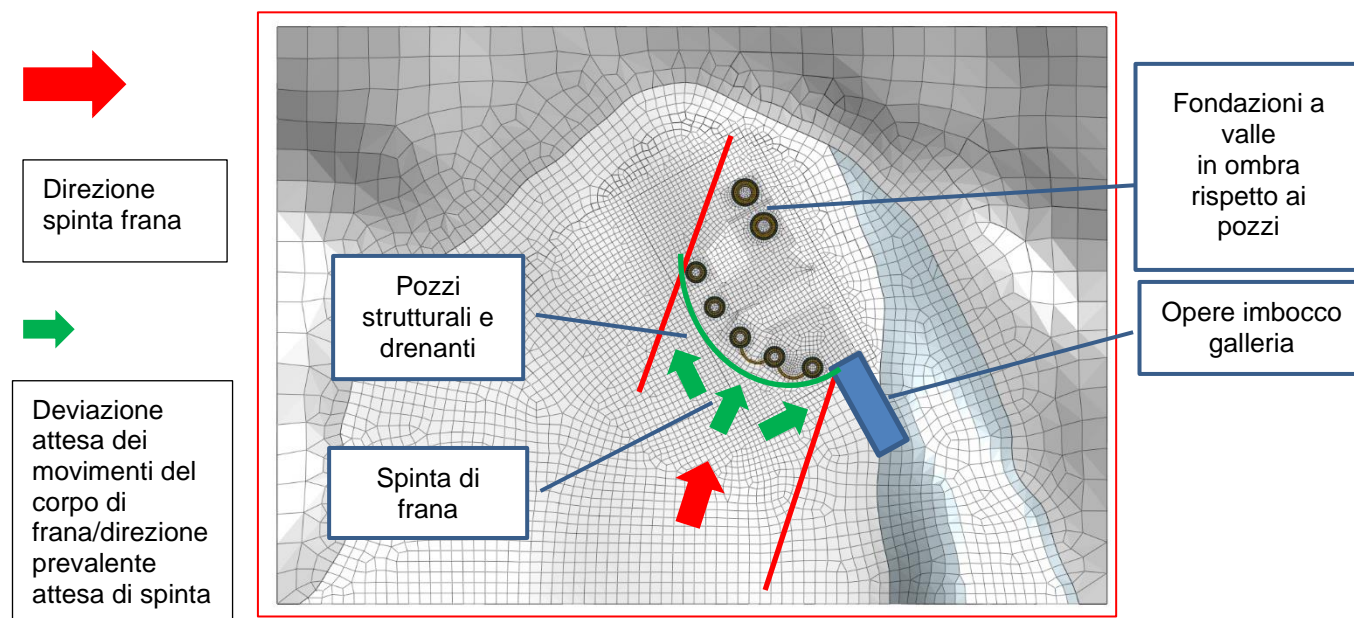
Considerazioni sulla disposizione planimetrica dei pozzi e protezione delle opere di linea
